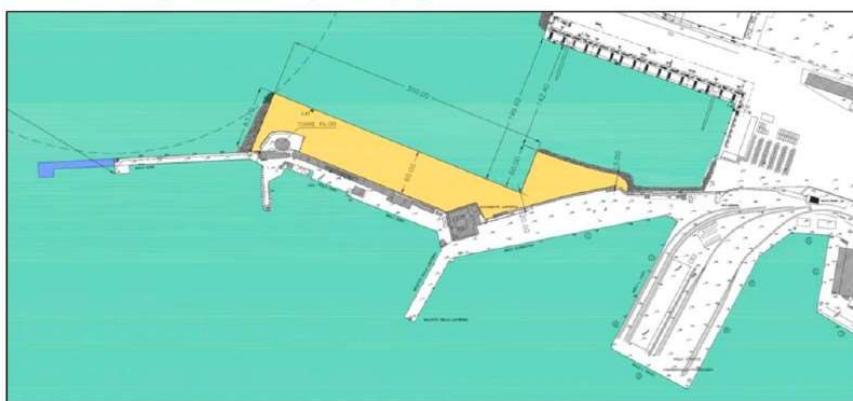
Planimetria generale di progetto SOLUZIONE 2 con retrobanchina.
